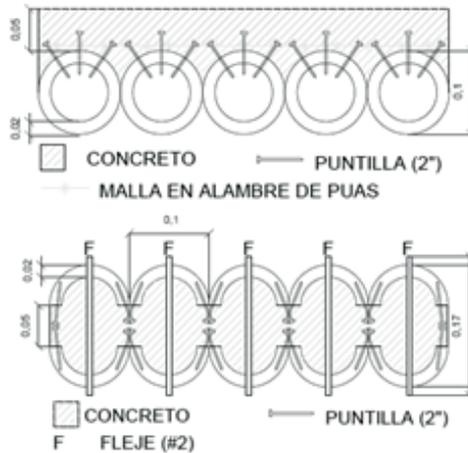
(a) Diagrama de la sección transversal de un entrepiso. (b) Diagrama de la sección en planta de un Tabique
